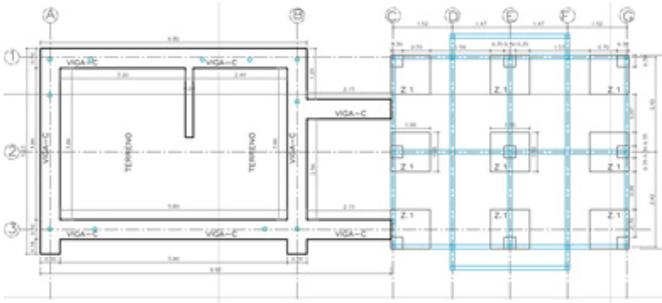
Planta estructural de vigas de cimentación de vivienda modular sostenible
